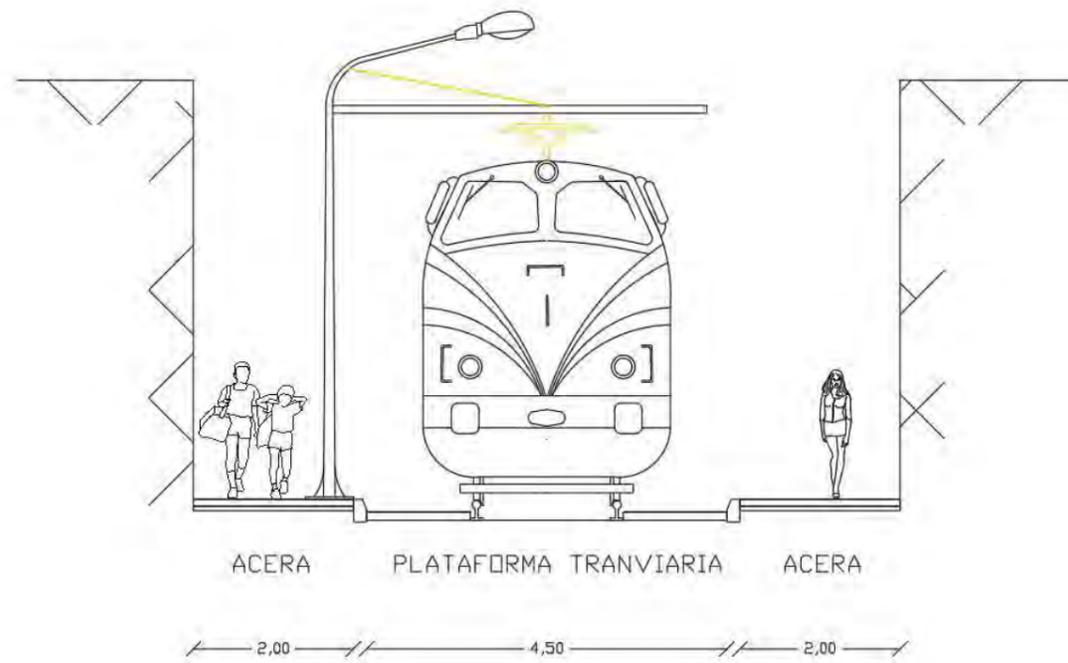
Sección tipo A (cotas en m). Fuente: Elaboración propia
